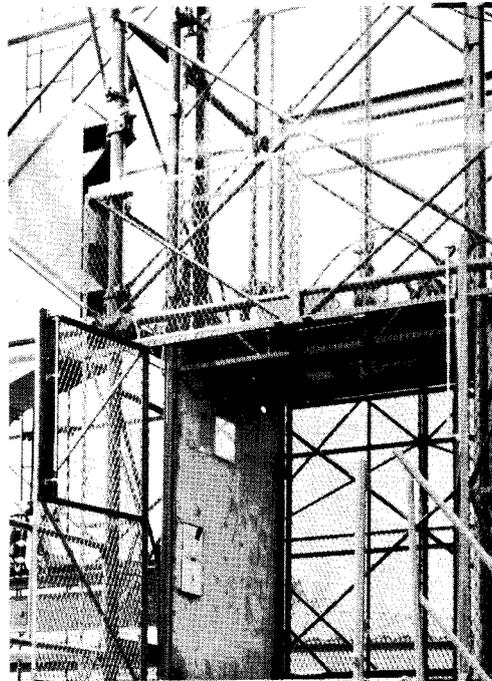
Vista demostrando la barrera del apeadero y la puerta del carro, ambas abiertas.
